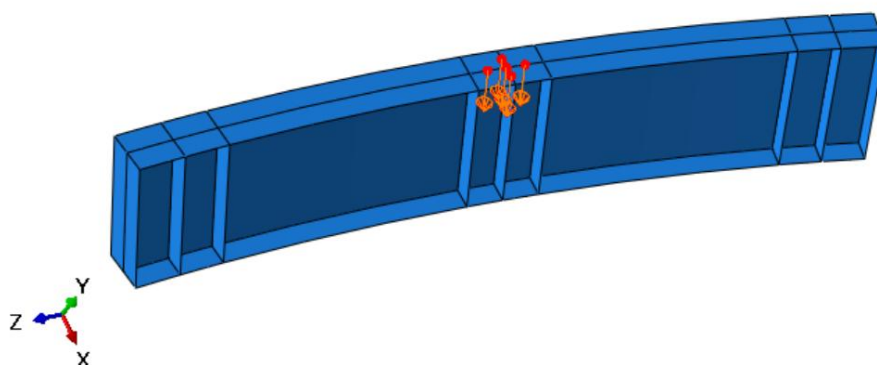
Tipo do carregamento aplicado no centro da viga.
